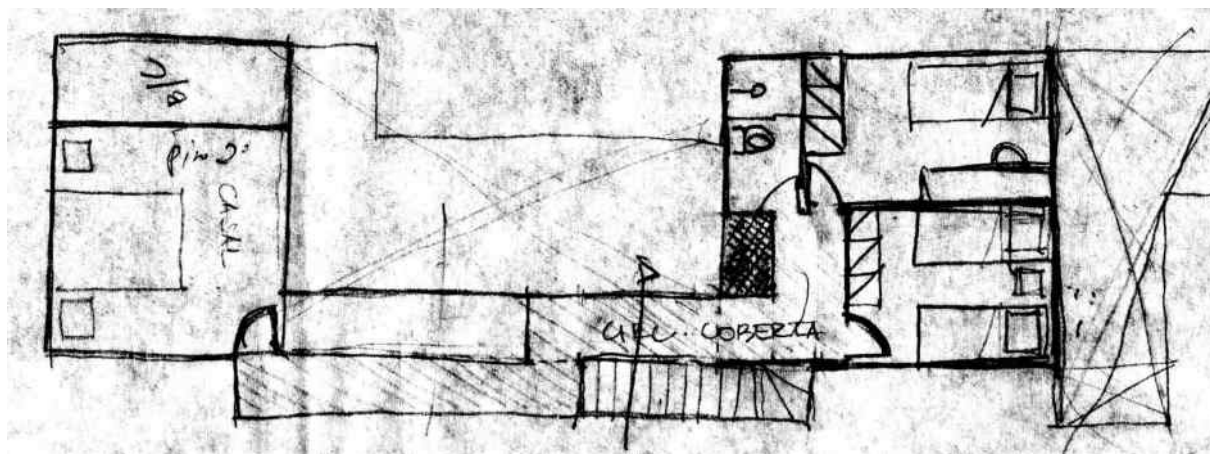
Estudo para solução em planta do projeto da equipe 7.
